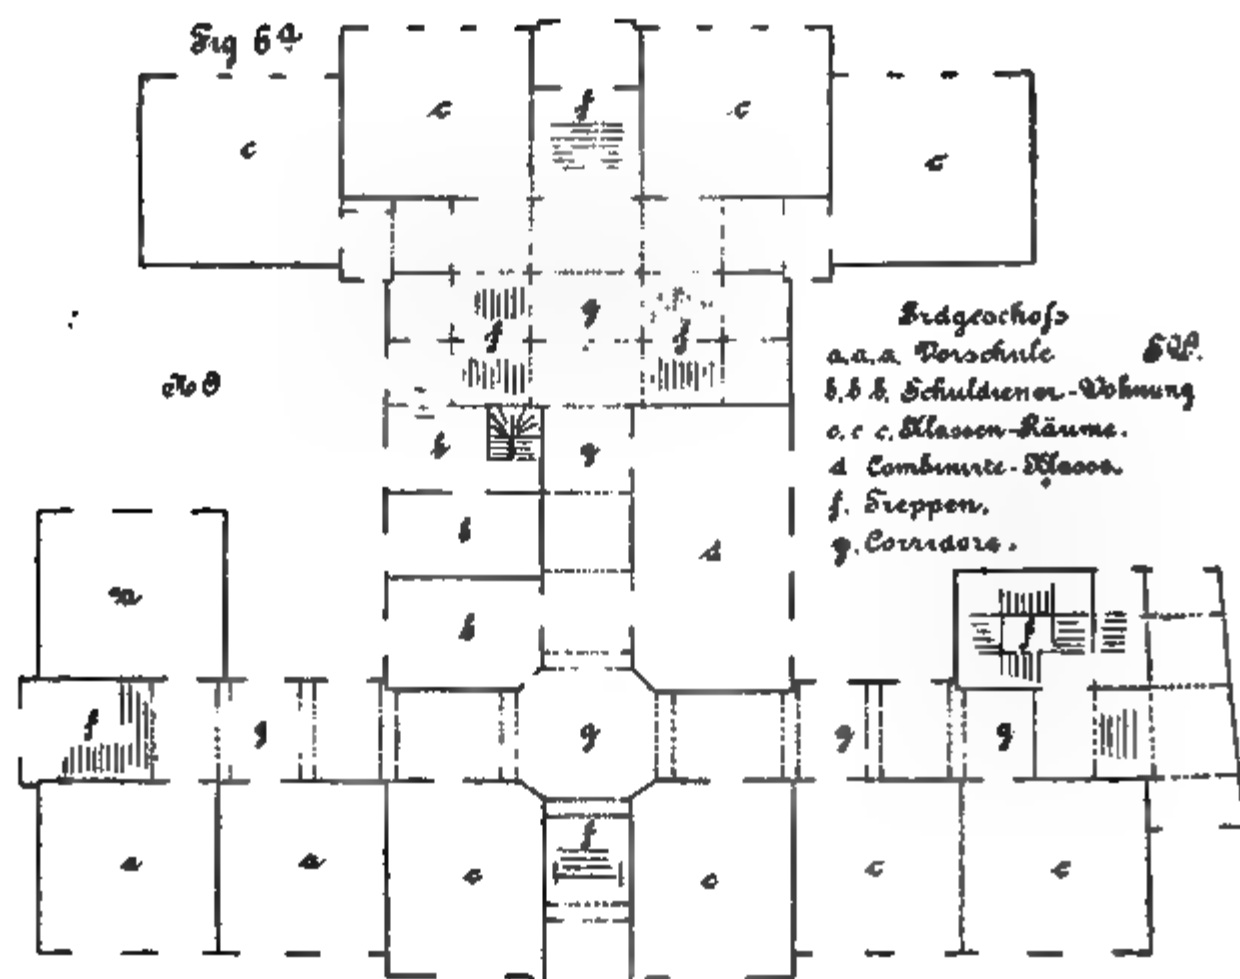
zeigt den Grundriss des Erdgeschosses im Bonner Realprogymnasium.
